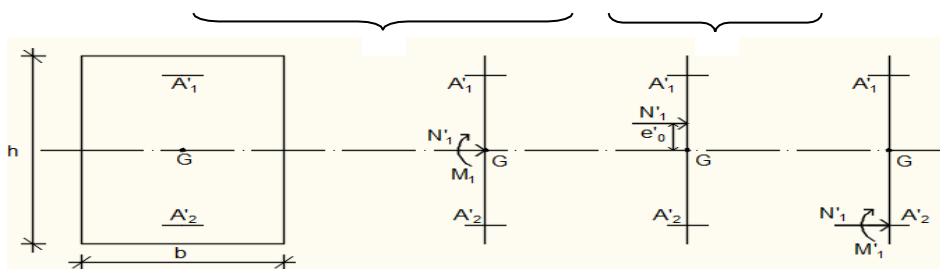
Position de N'1 M'1 et M1 sur la section transversale.
